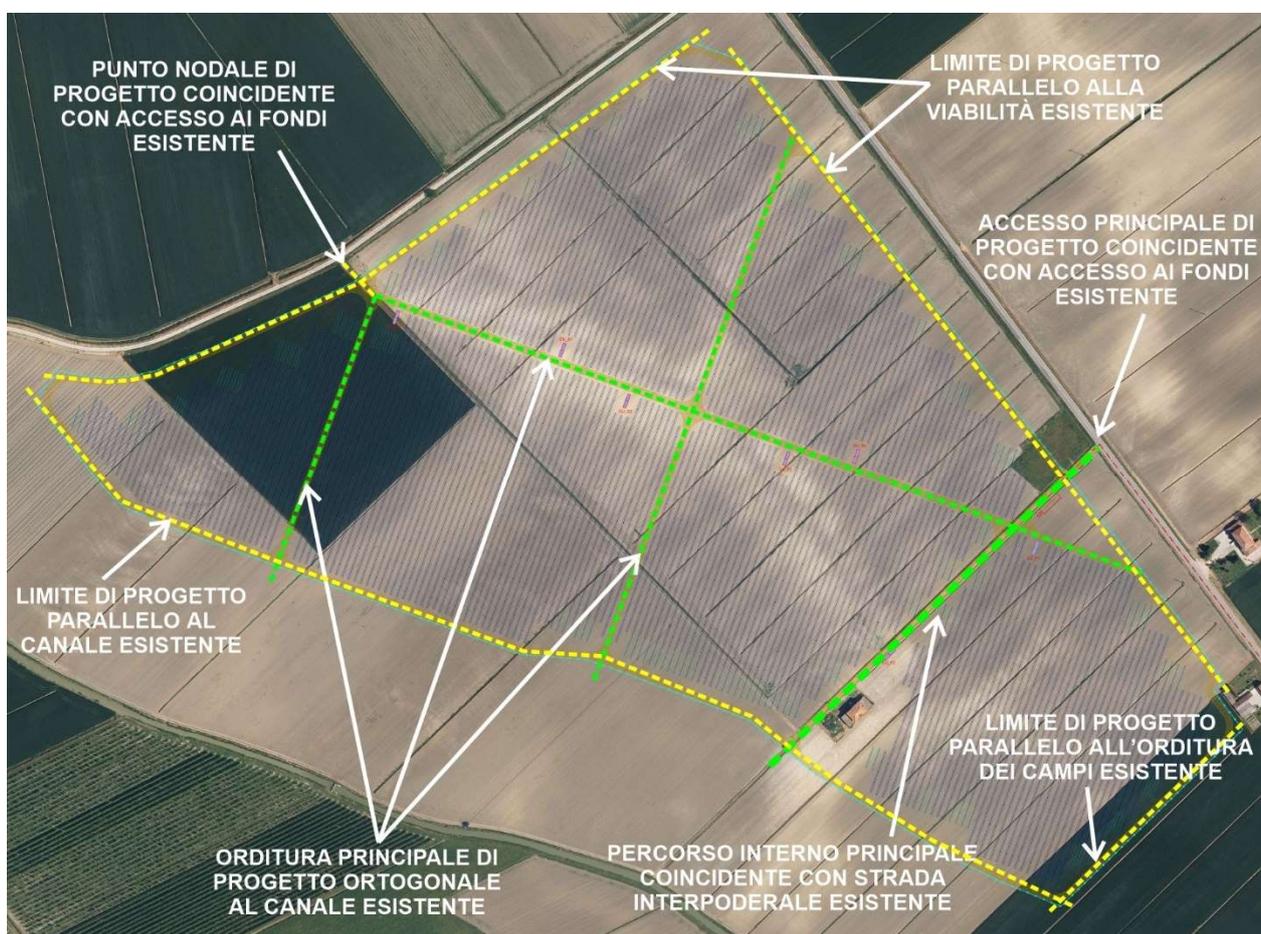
Layout impianto su ortofoto con indicazione dei tracciati caratterizzanti
